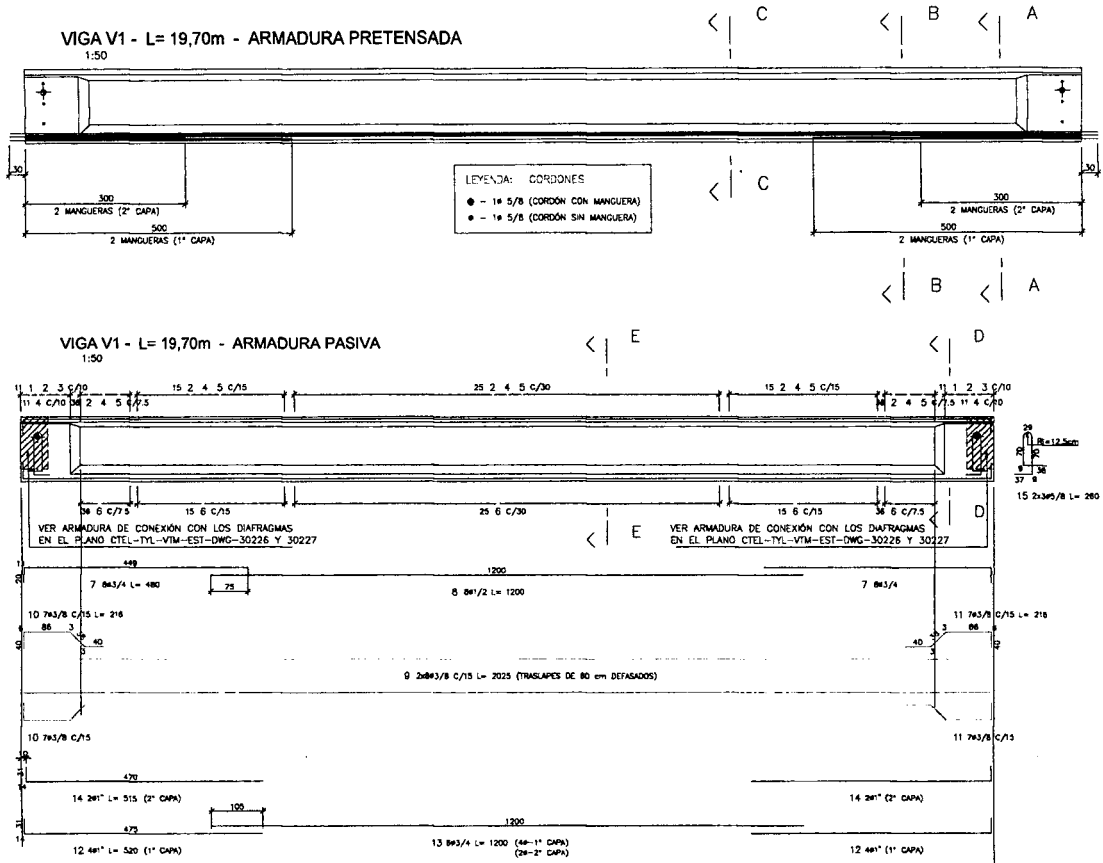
Detalle del acero de refuerzo longitudinal de la viga.
